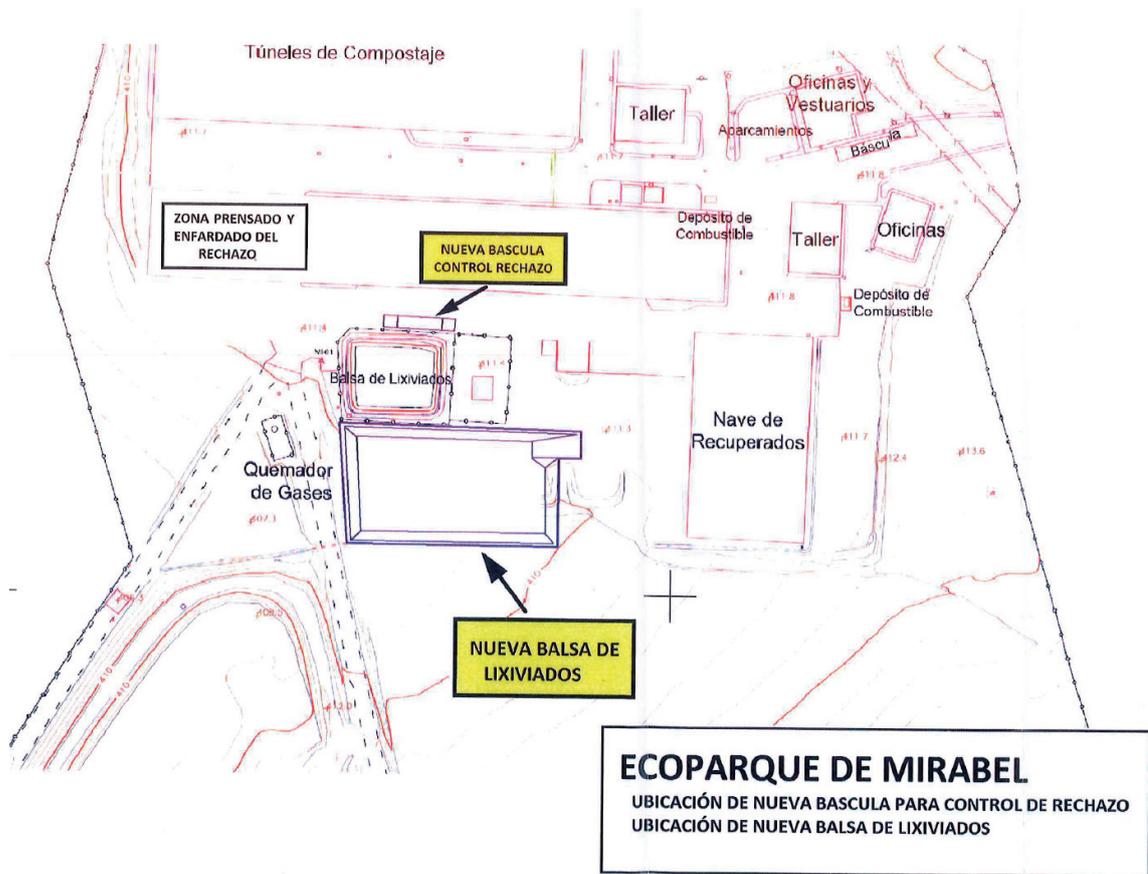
Plano 1 en planta de la instalación. Zona de tratamiento.
